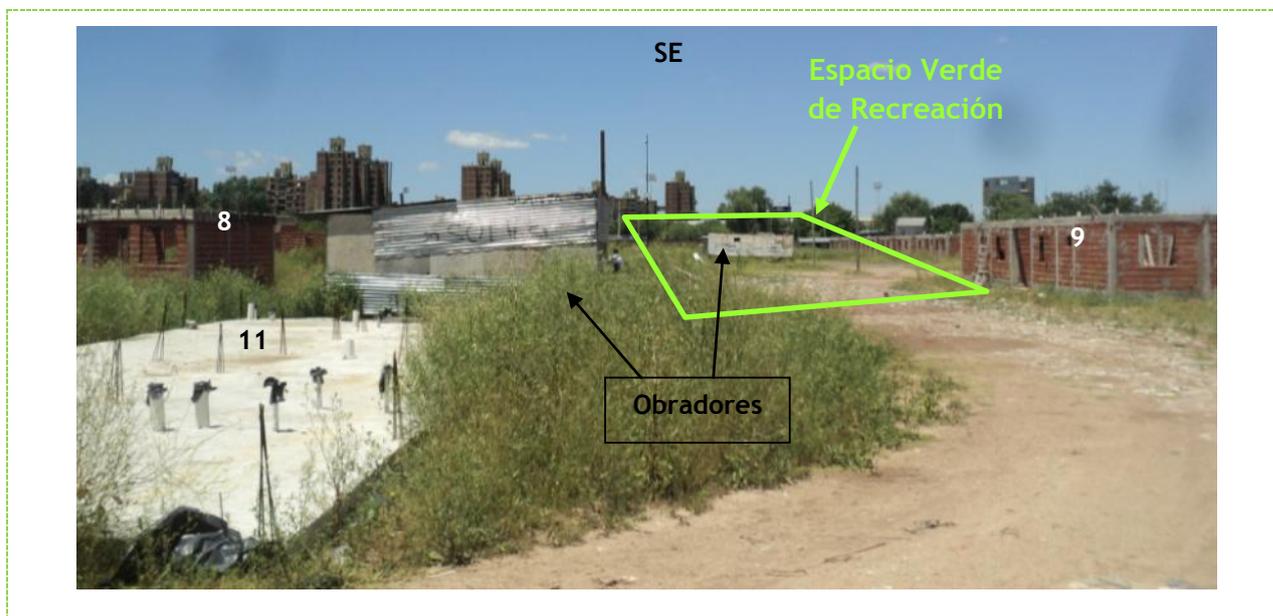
Vista general del predio desde el margen norte hacia el SE. Se observa el área central del Plan de viviendas donde se ubicará el Espacio Verde de Recreación. Asimismo se observan dos obradores. Se detalla el número de las Manzanas del Plan de viviendas en la imagen.
